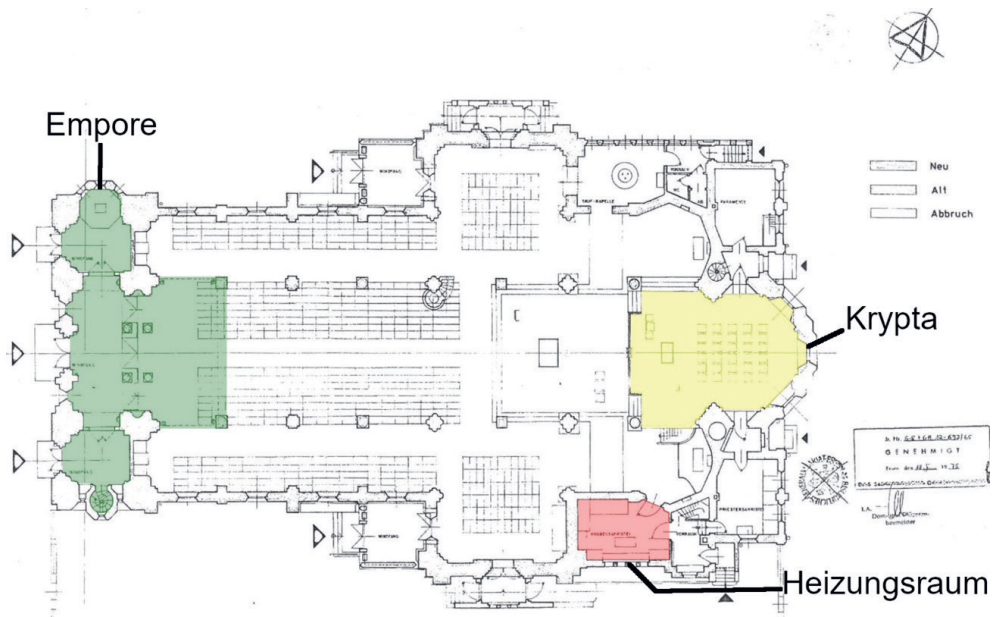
Grundriss der Kirche St. Joseph (Quelle: Greinsberger)
